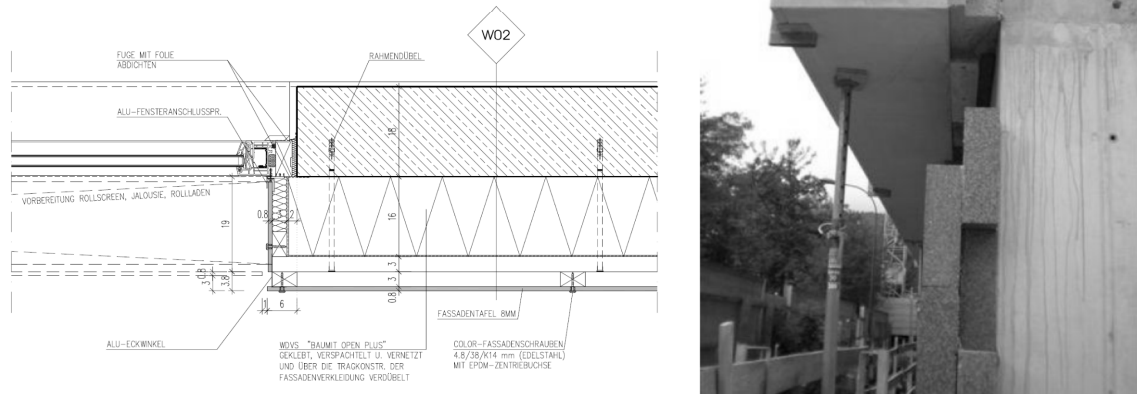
Detalle de fachada del proyecto de 354 viviendas pasivas en Lorenareal, Innsbruck Austria. dinA4 y Team K2 arquitectos. Ayuntamiento de Neue Heimat Tirol. www.nht.at. Desde el interior 18 cm de hormigón armado, 16 cm de aislamiento de poliestireno de alta densidad y sistema de fachada ventilada [www.nht.at].
